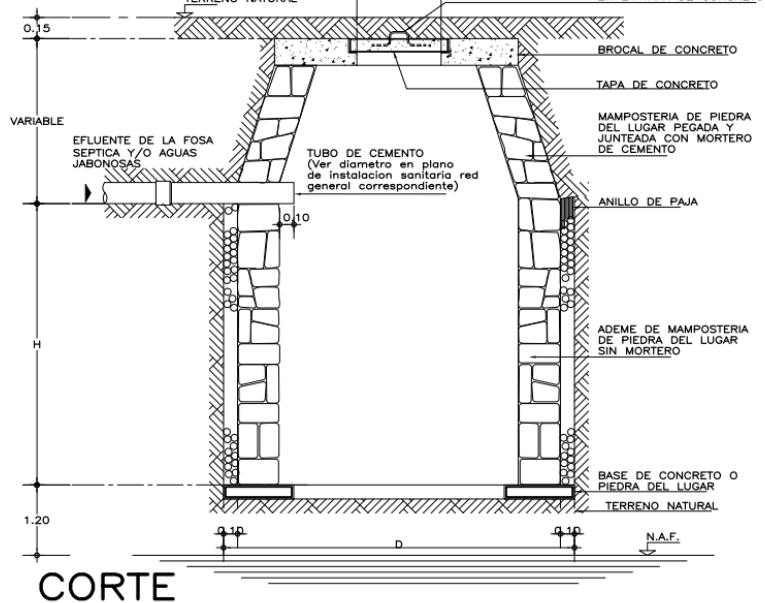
Pozo de absorción/infiltración Construido in-situ⁵¹
